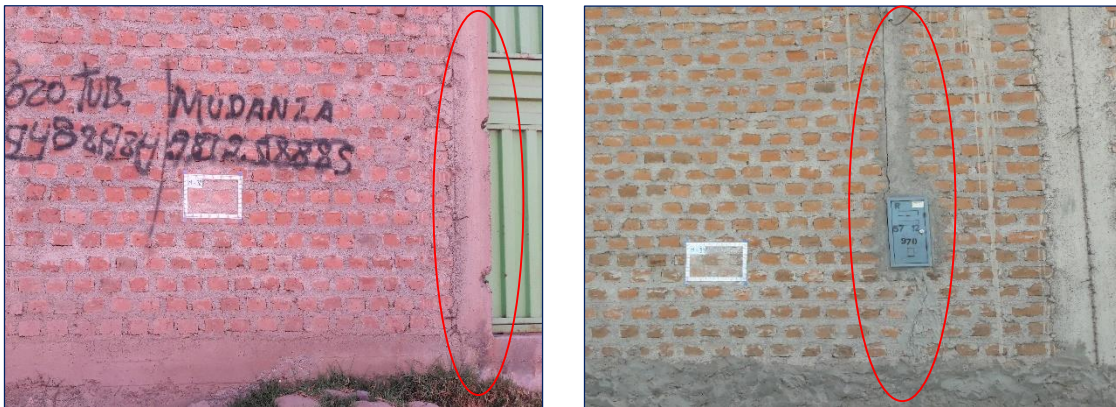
No existen vigas soleras en algunas de las viviendas analizadas.
